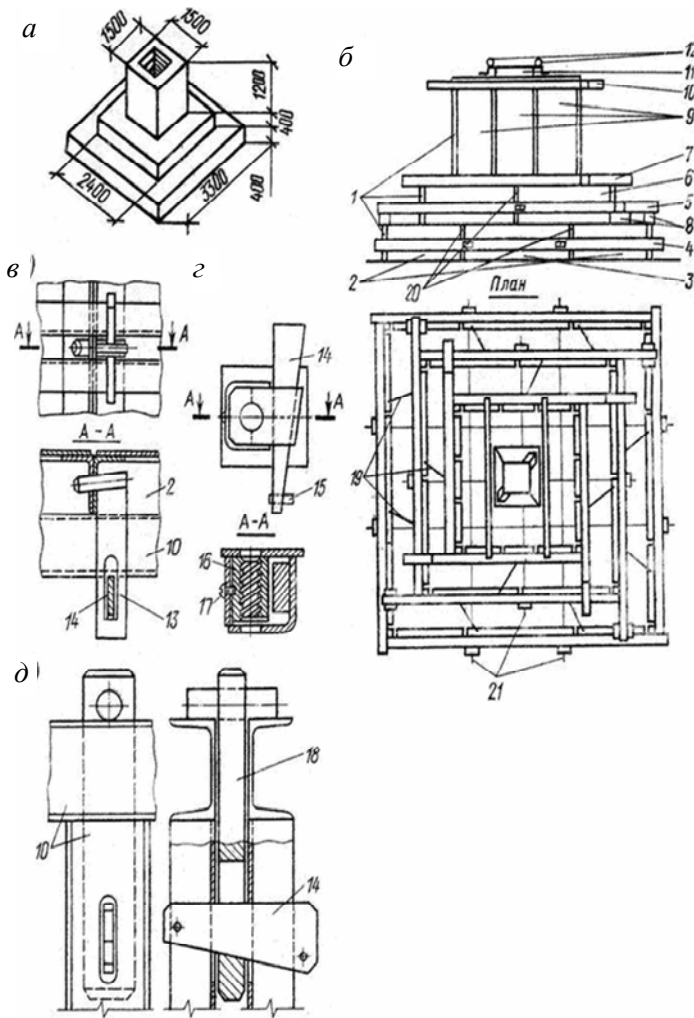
Пример конструирования мелкощитовой опалубки фундамента:
